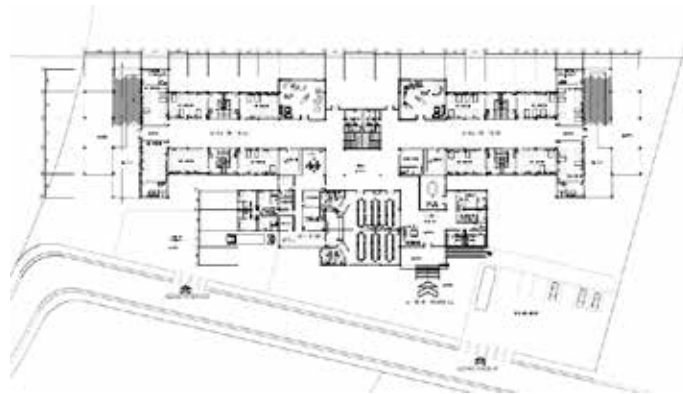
Planta baja conjunto de la Casa Hogar Permanente. Fuente: PDF. (2018)
